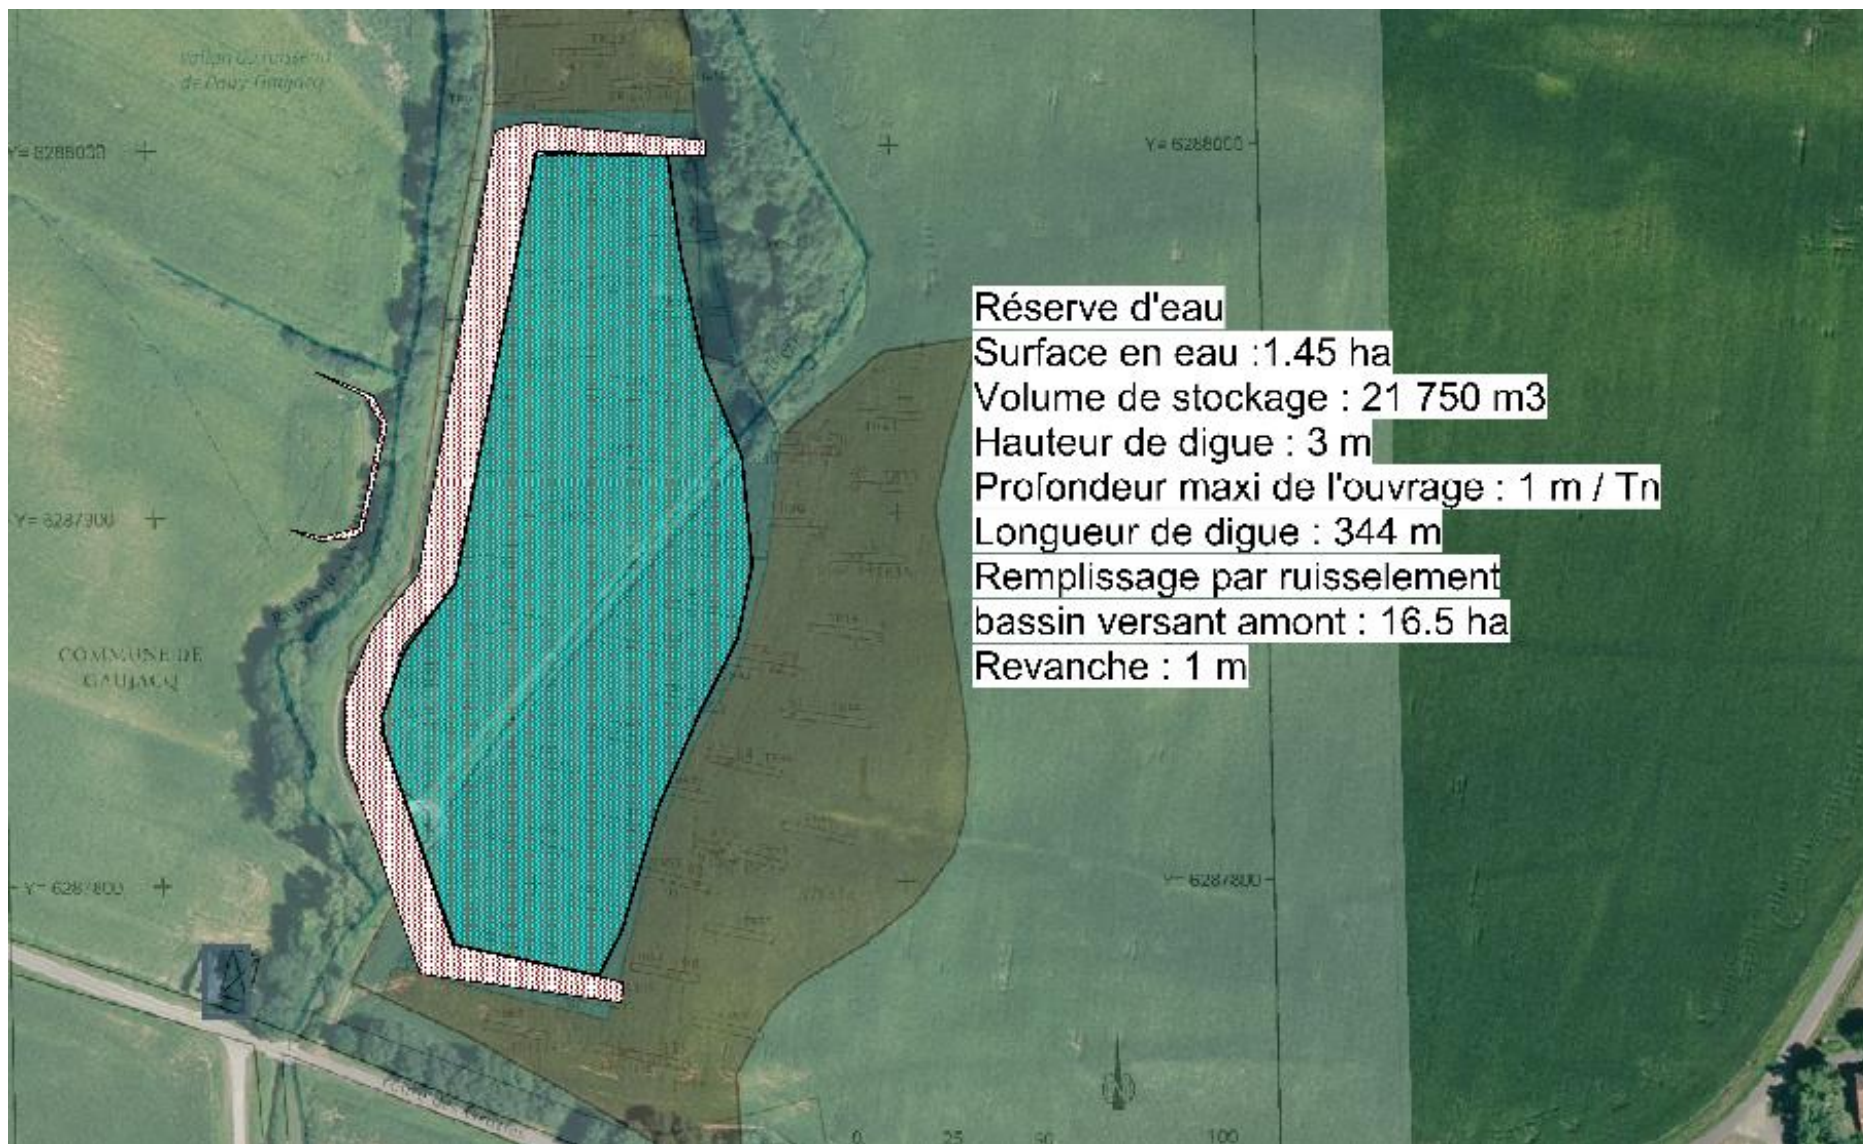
Plan de masse du Projet (Source : EARL de BONNEHE)
